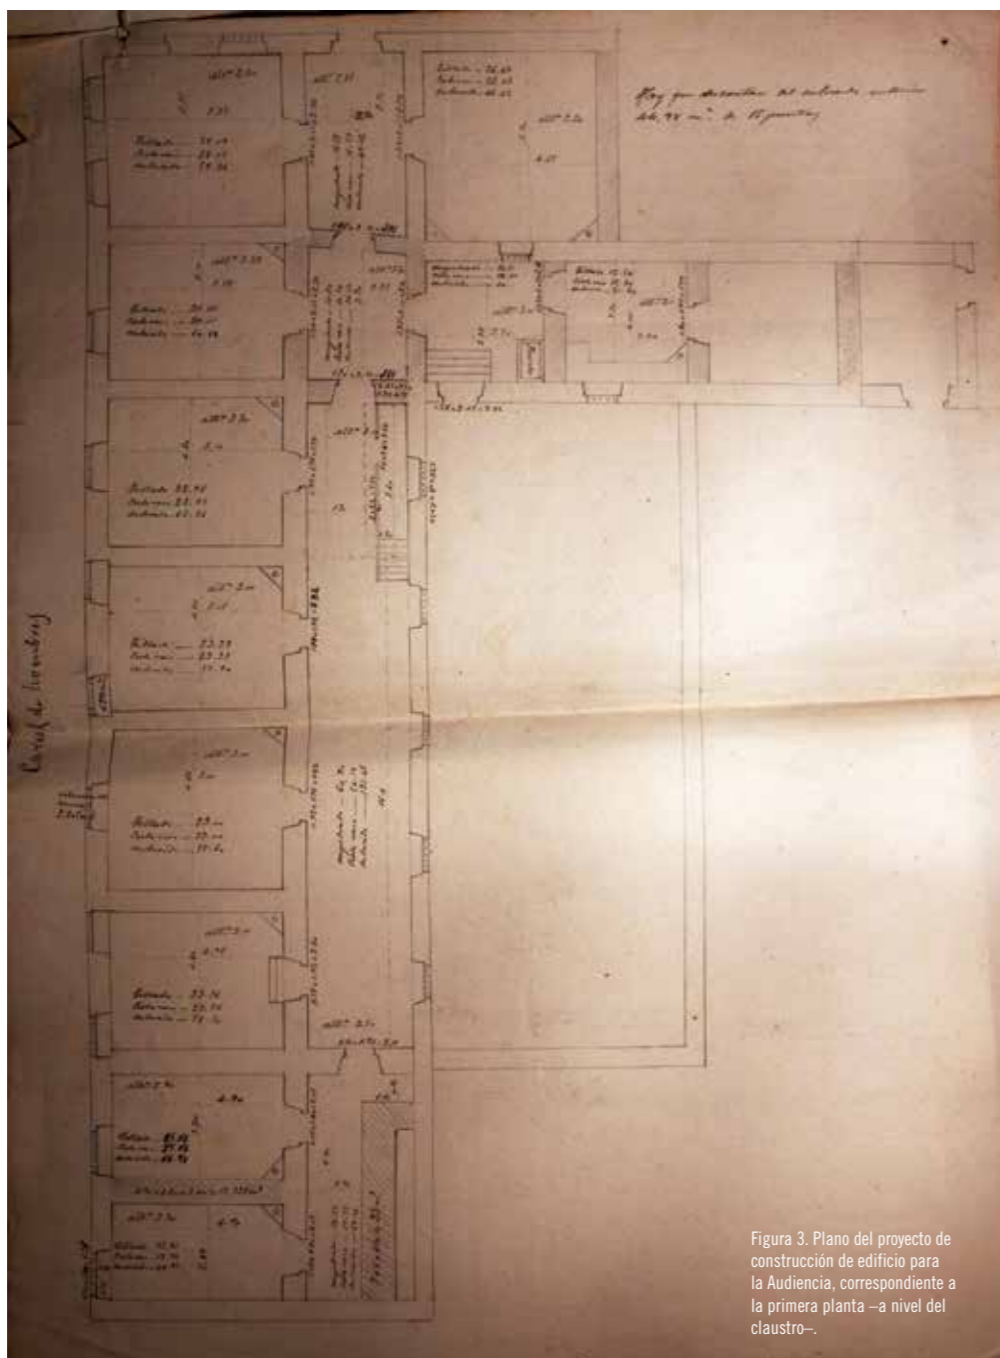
Plano del proyecto de construcción de edificio para la Audiencia, correspondiente a la primera planta –a nivel del claustro–.
